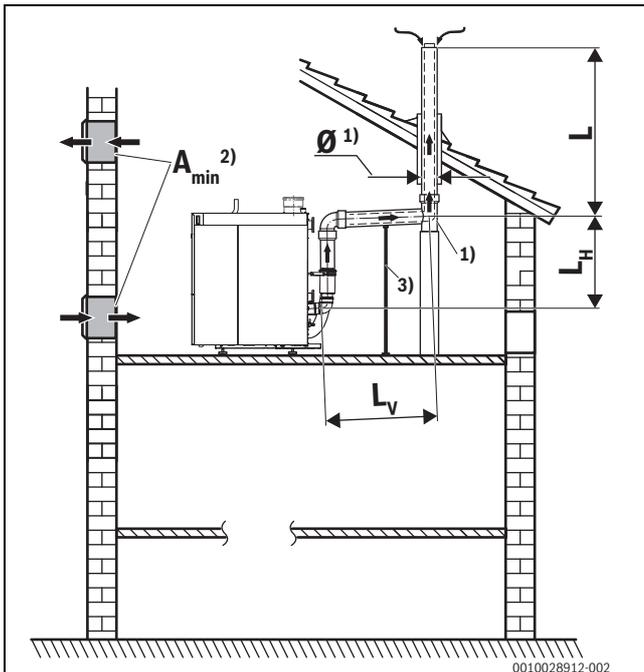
Abgasleitung, Dachzentrale, Variante 3
